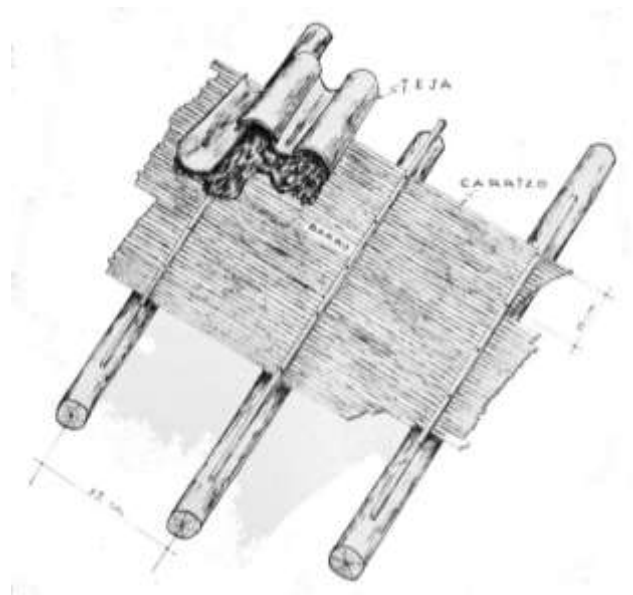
Detalle constructivo cubierta de teja sobre barro.
